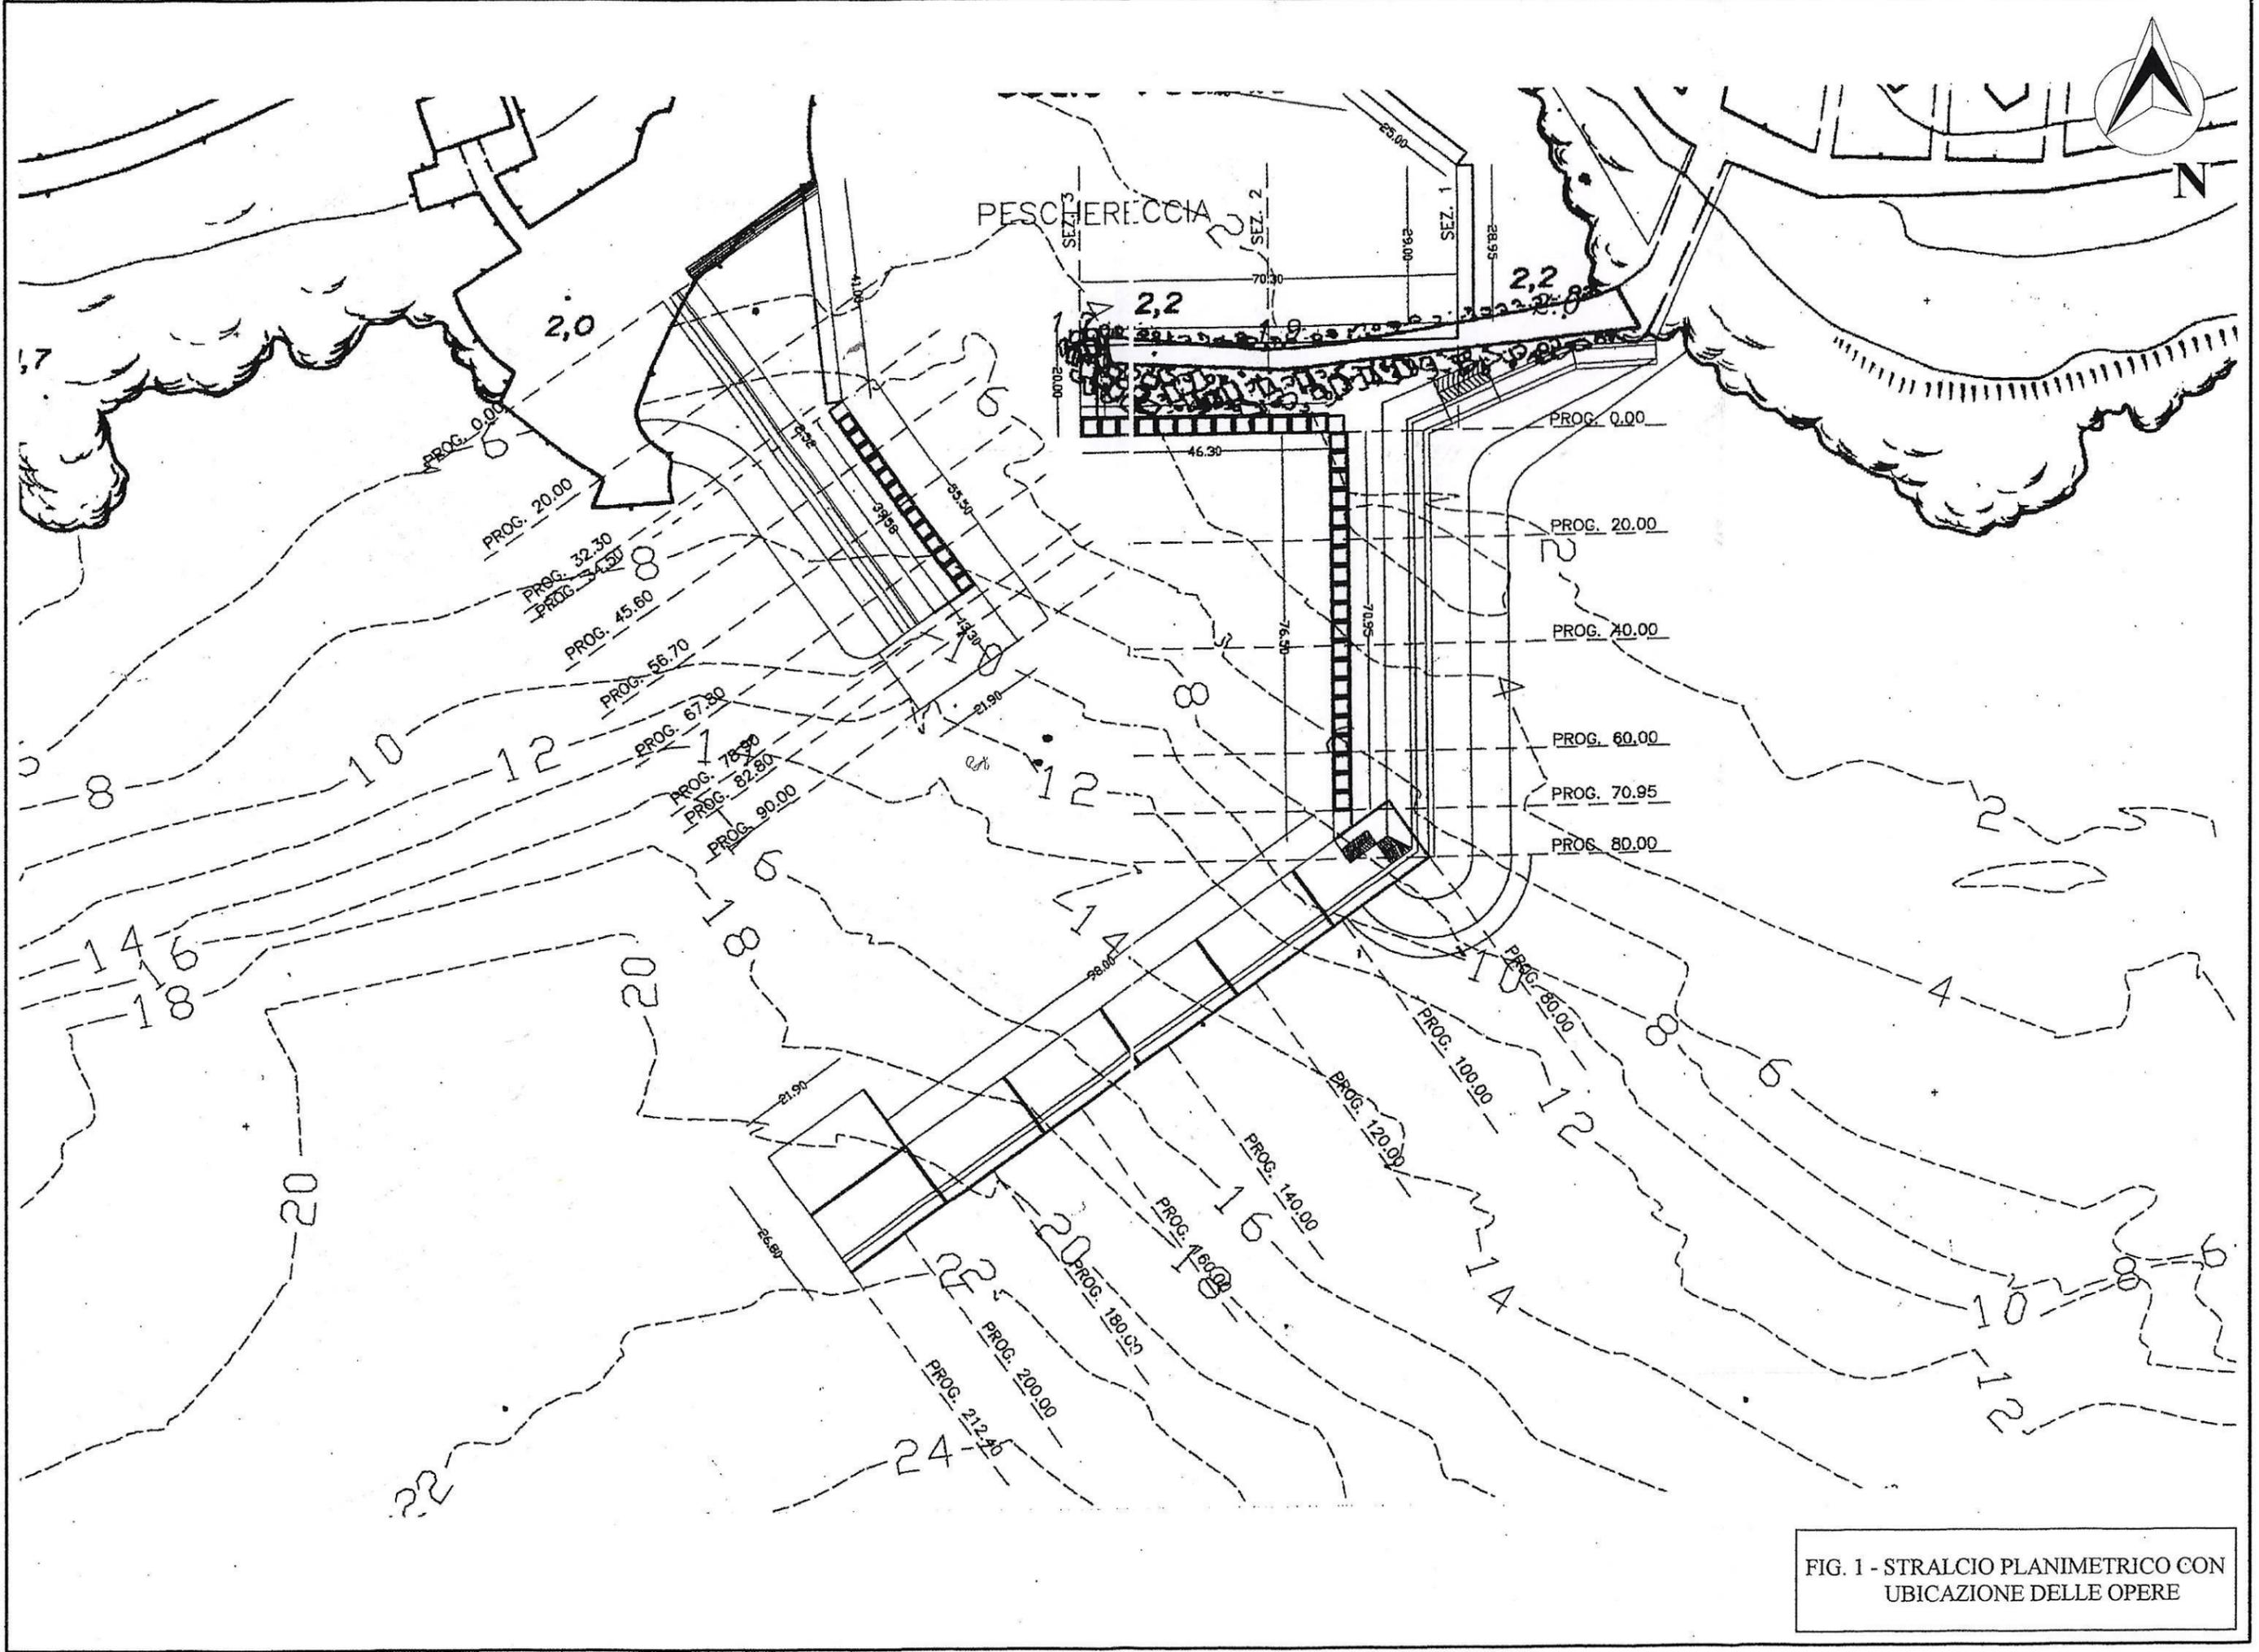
STRALCIO PLANIMETRICO CON UBICAZIONE DELLE OPERE
